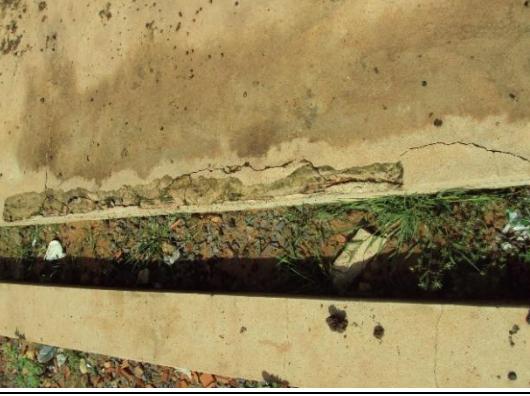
Vista da quadra escolar	Foto 2 – Recalque na calçada, com rachadura
